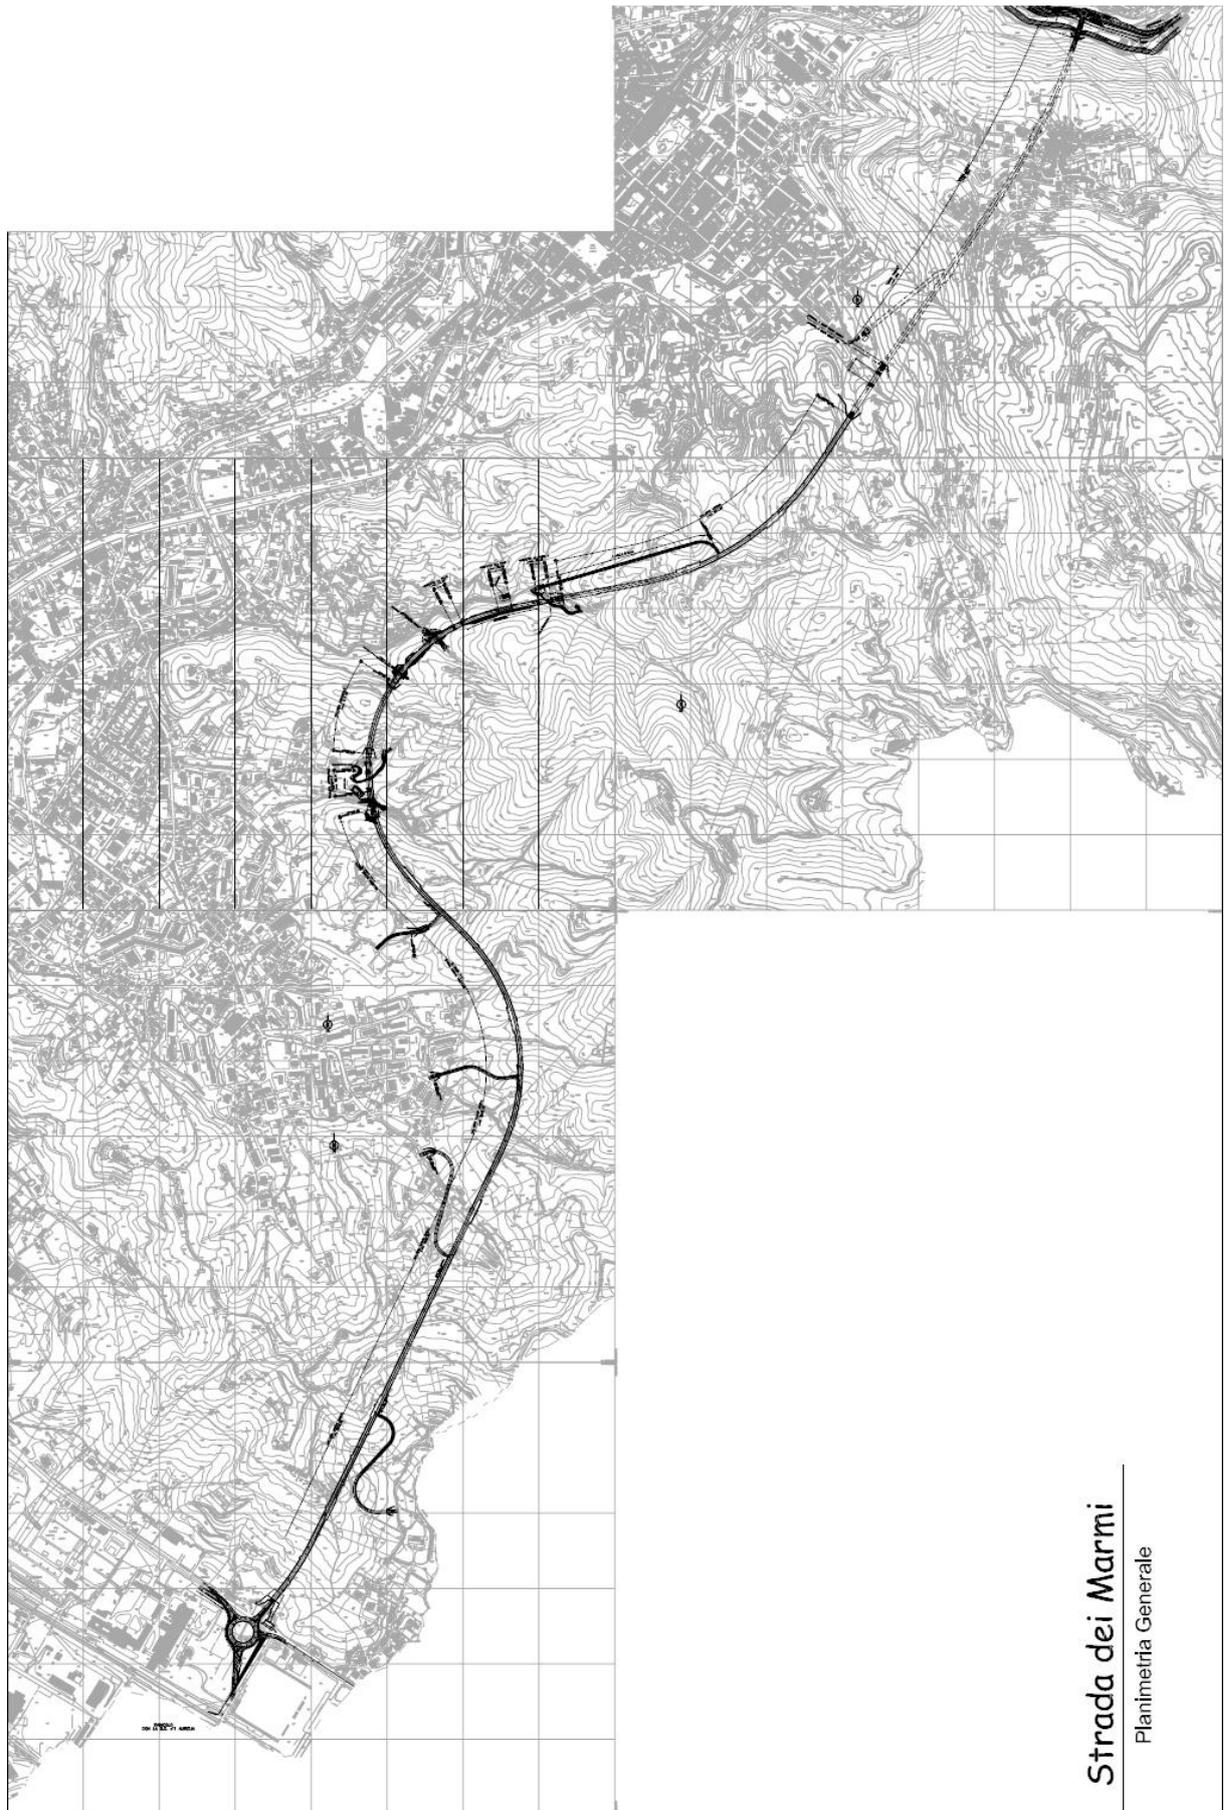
Strada dei Marmi. Planimetria Generale
